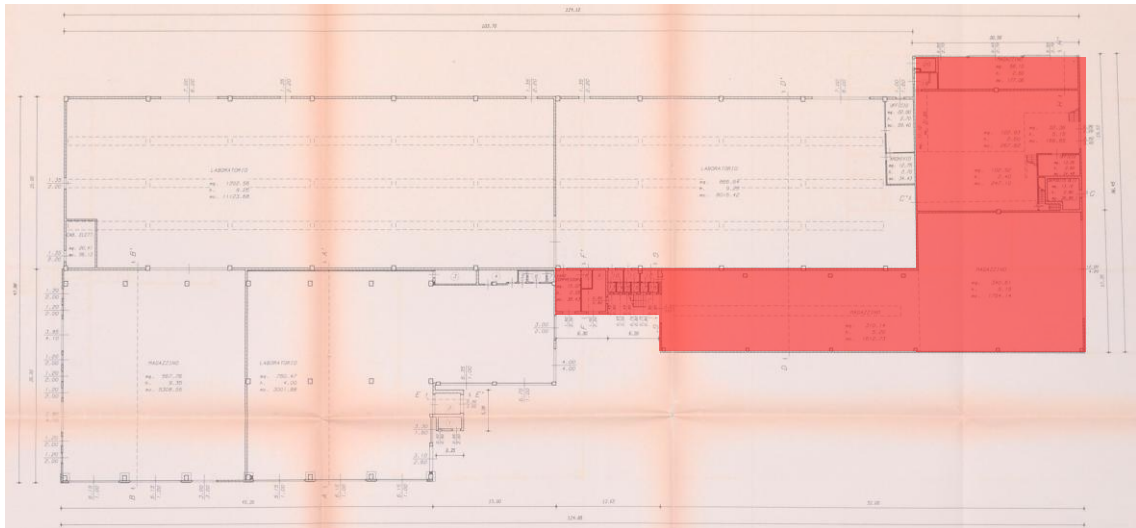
Particolare di A.1990.cap.us.T02 - Pianta piano terra - Strutture demolite
